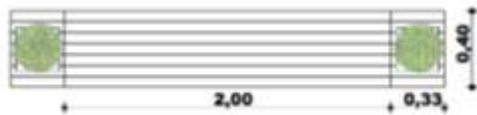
Perfil Vial Propuesto (Sendero Mavecure)
